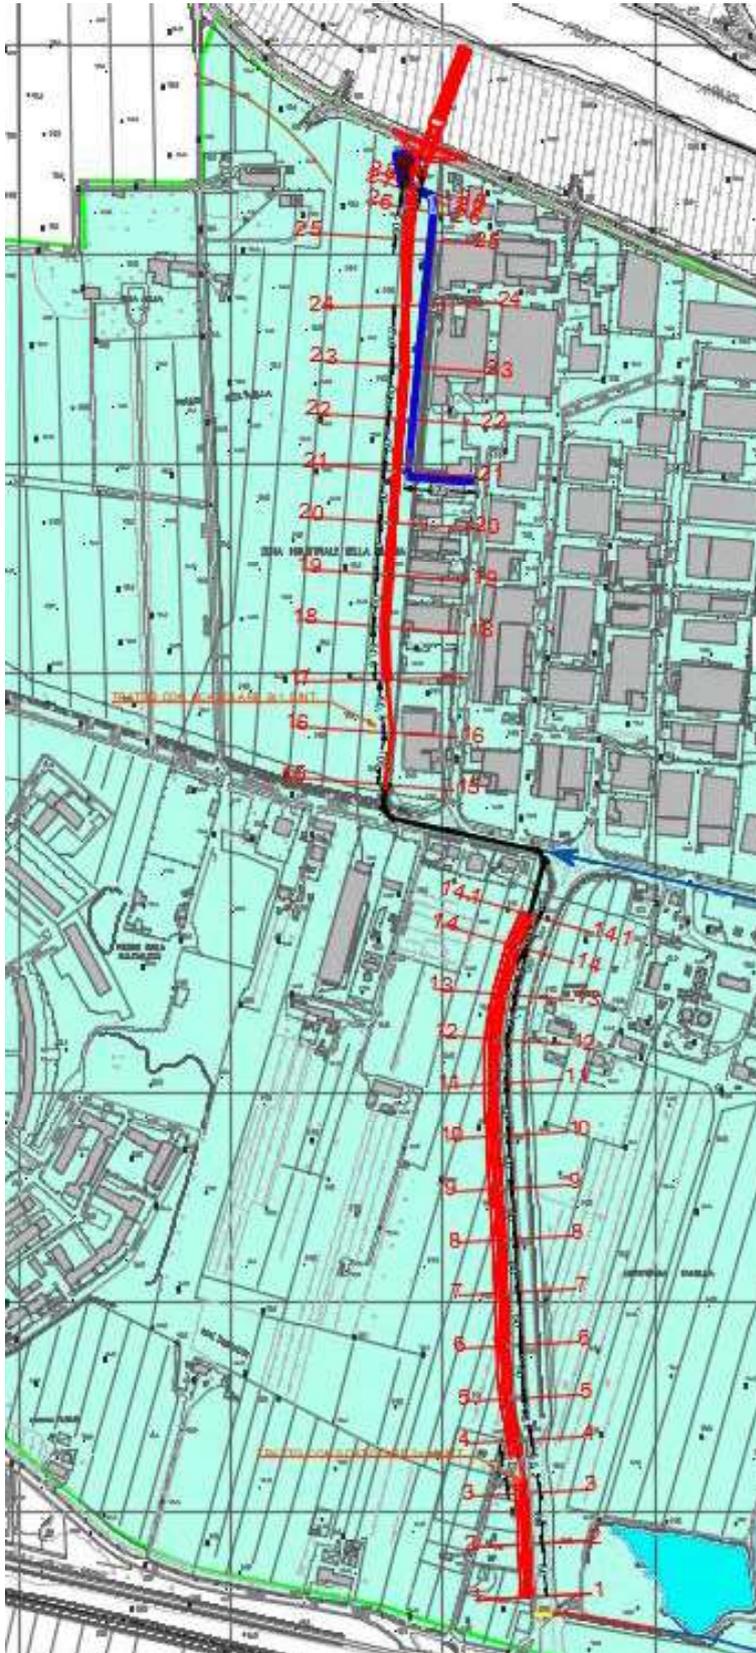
Canale di drenaggio cui fa capo l’Impianto idrovoro.
